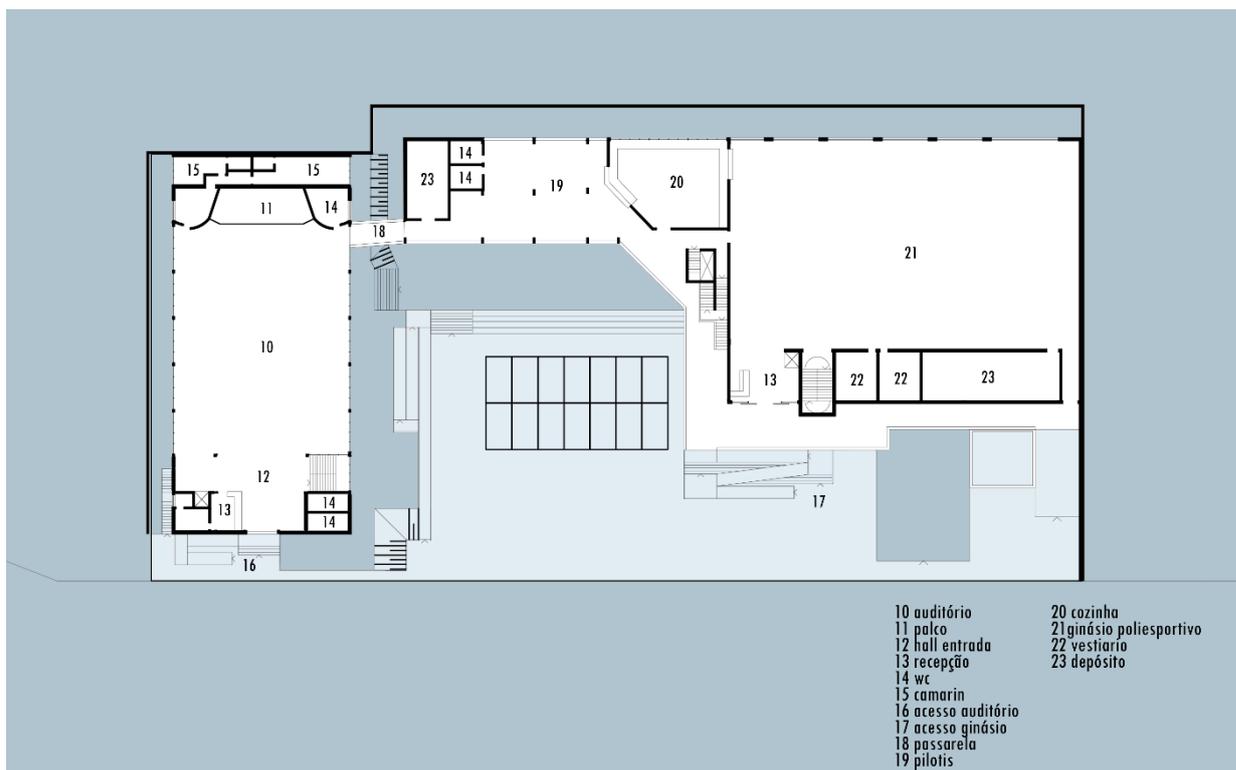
Planta Baixa Reabilitada - TÉRREO. Fonte: produzido pela Autora.
